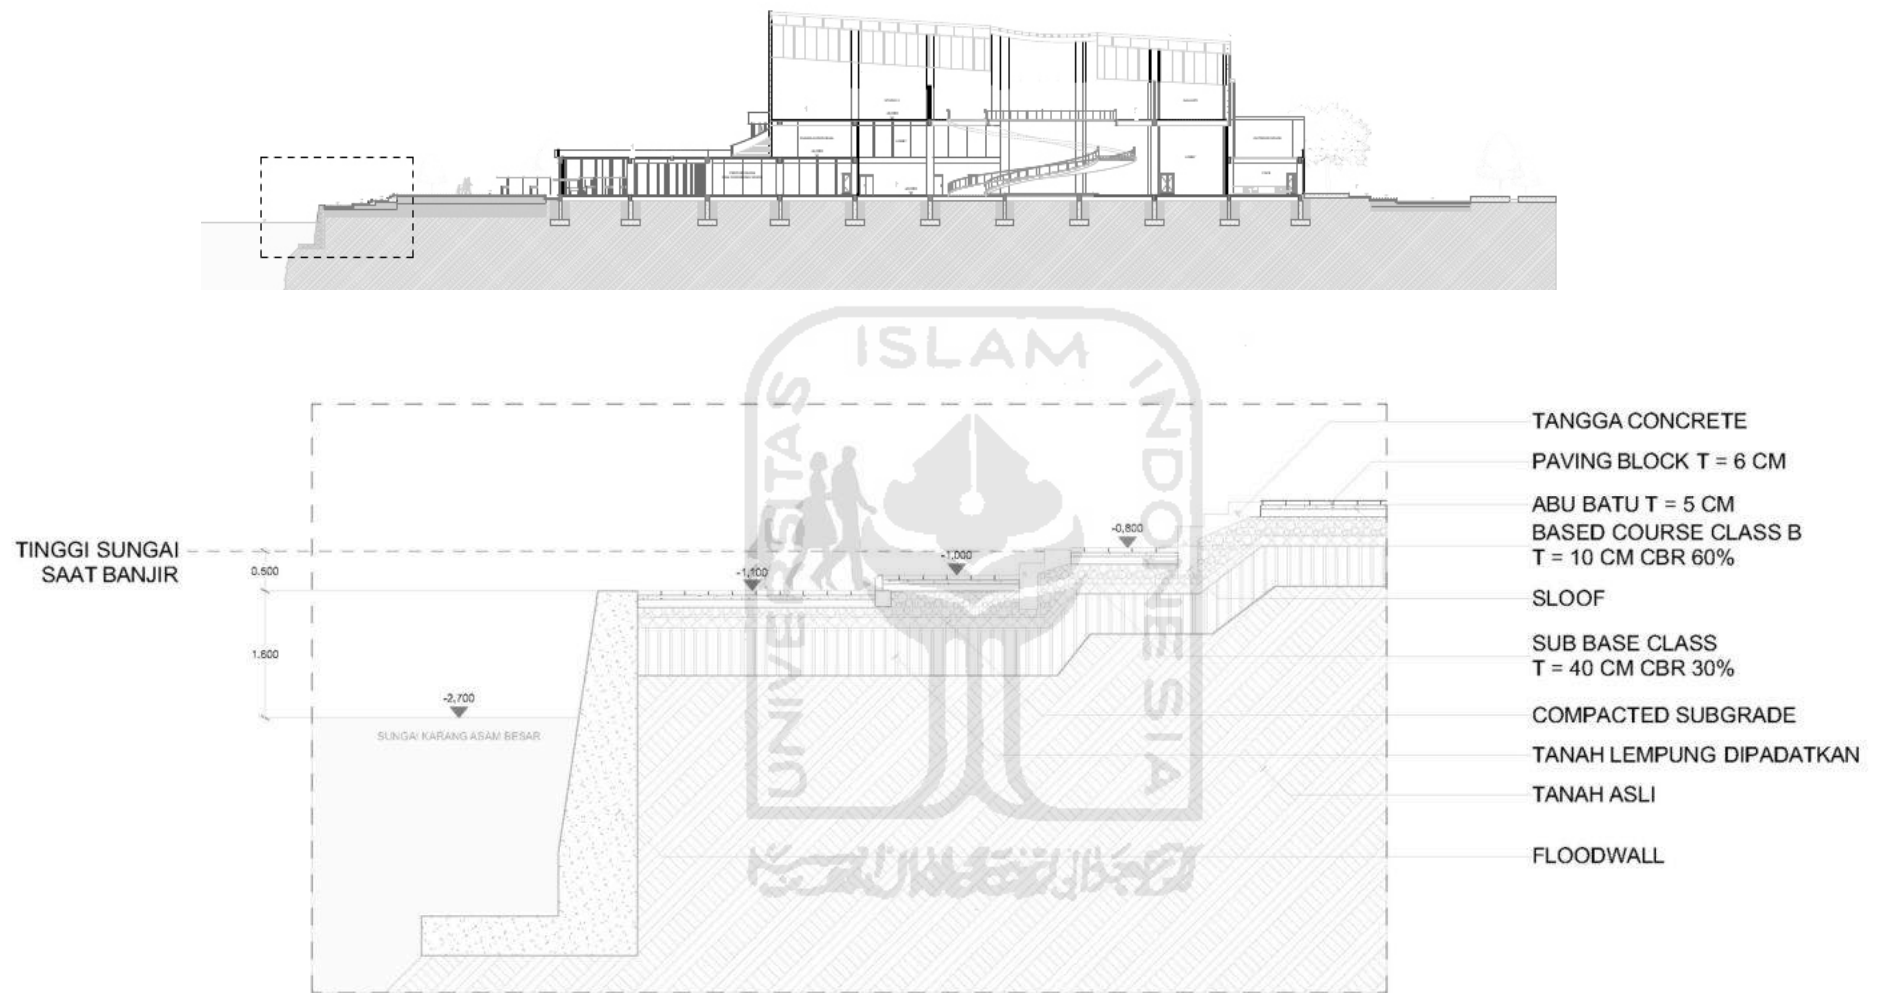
Potongan bangunan s-02 (Sumber: Penulis, 2021)
